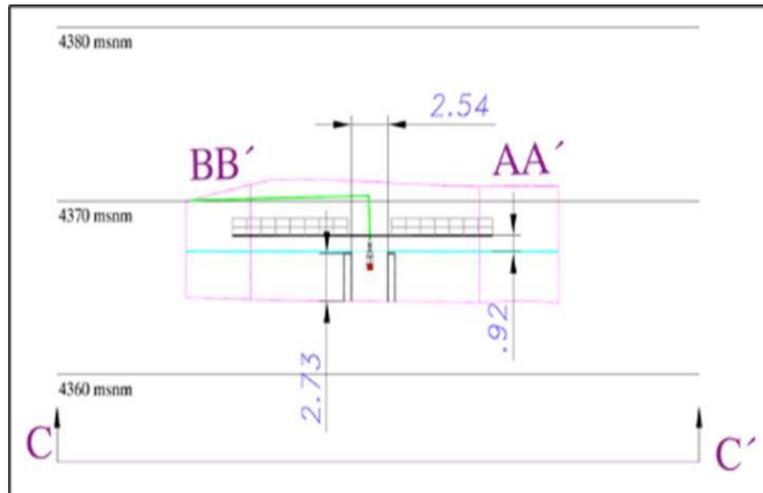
Plano en corte de la ubicación de la bomba luego de construir el muro
